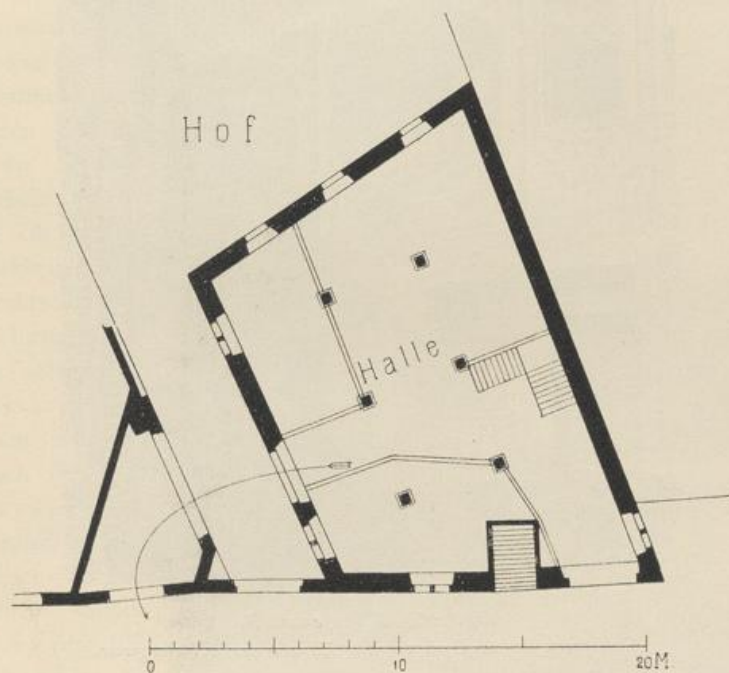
Wimpfen a. B. Grundriss des Riegelhauses Fig. 104.
